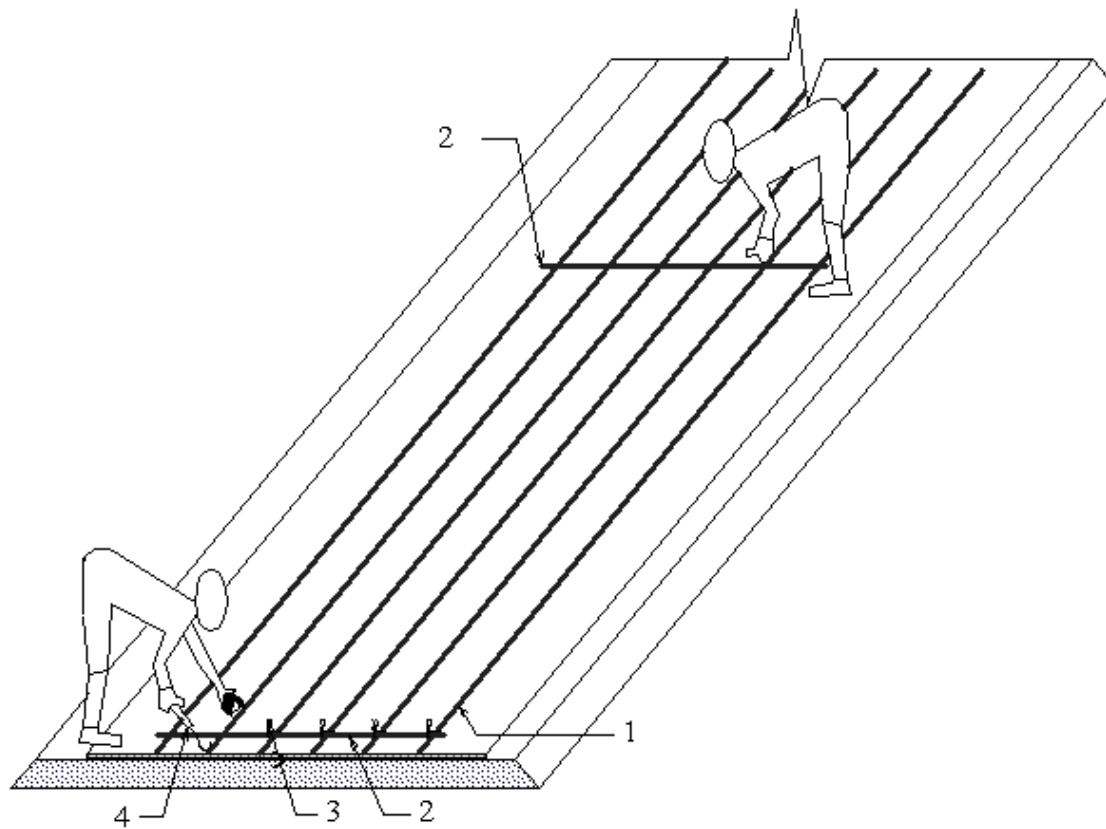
Укладка и закрепление поперечной арматуры: 1 – продольная арматура; 2 – поперечная арматура; 3 – закрепление узла пересечения вязальной проволокой
